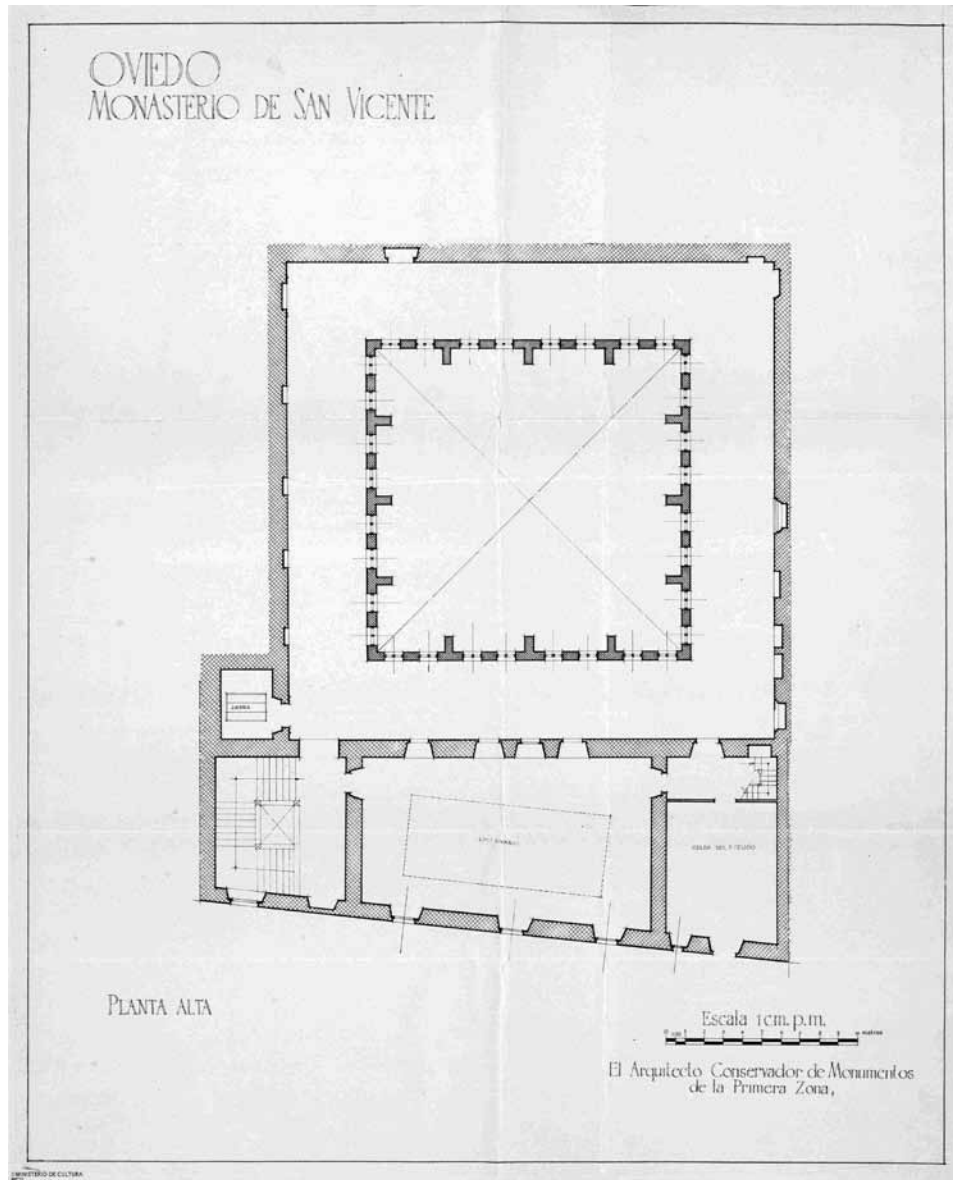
Plano del claustro de San Vicente de Luis Menéndez Pidal en 1941. Planoteca del IPCE (6166)
